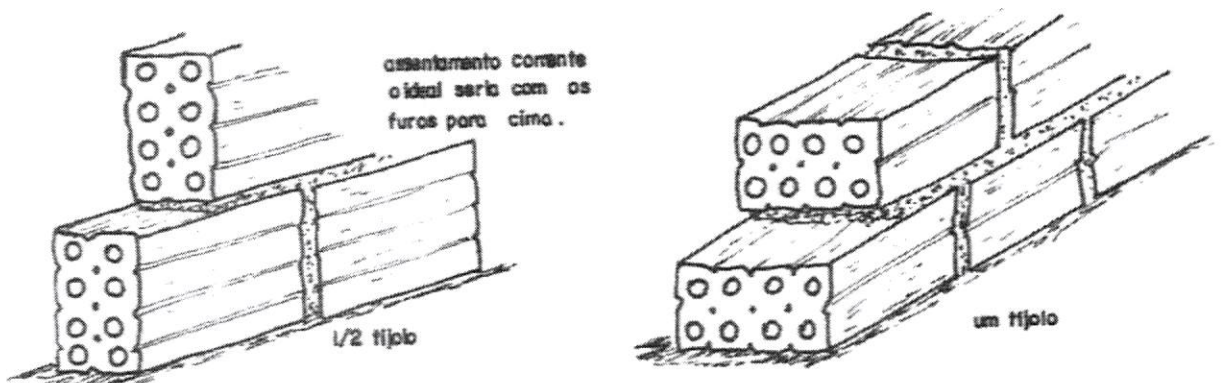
Execução de alvenaria utilizando tijolos furados.
